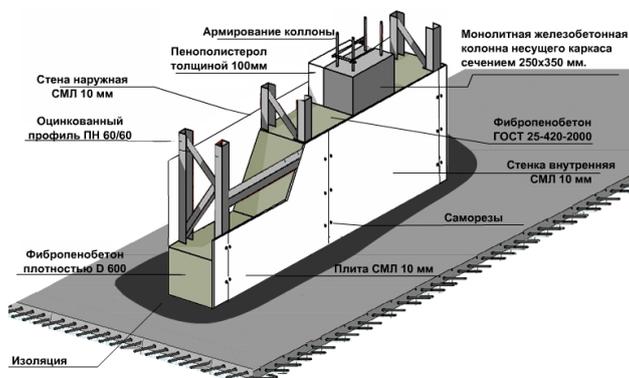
Разрез стены каркасно-монолитного строения: несъемная опалубка в виде наружной и внутренней стены из стекломагниевой плиты
